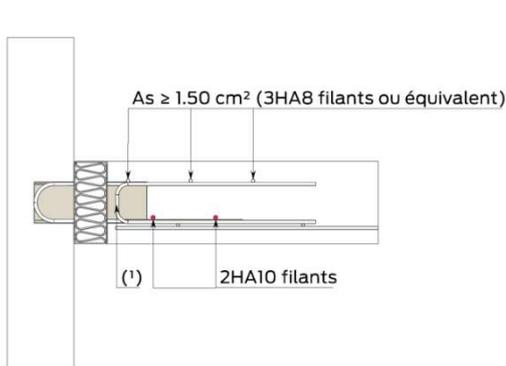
Disposition de chaînage de rive de plancher (vue en coupe)
